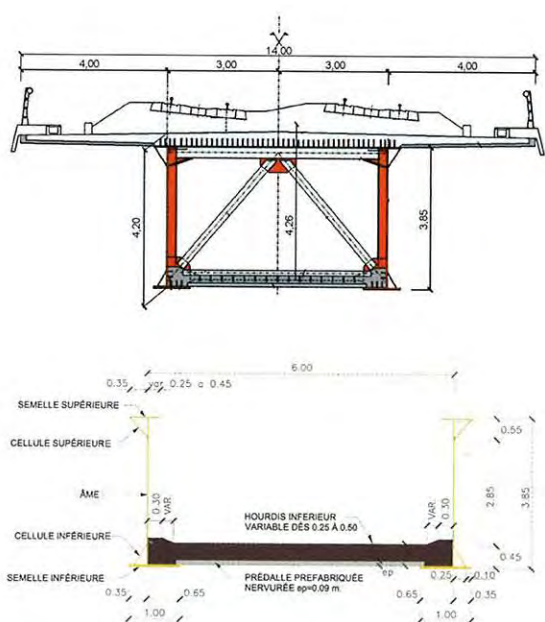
et 3b: Coupe sur pile / Cross section at piers
